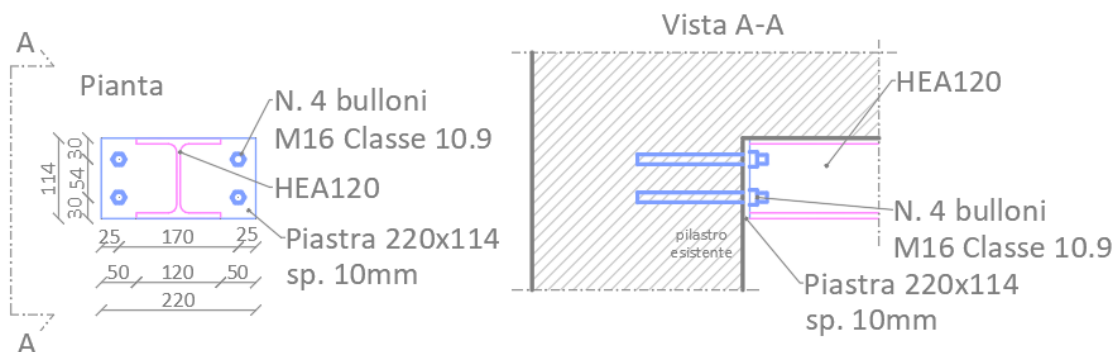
Particolare piastra di ancoraggio per aggancio trave – pilastro.
